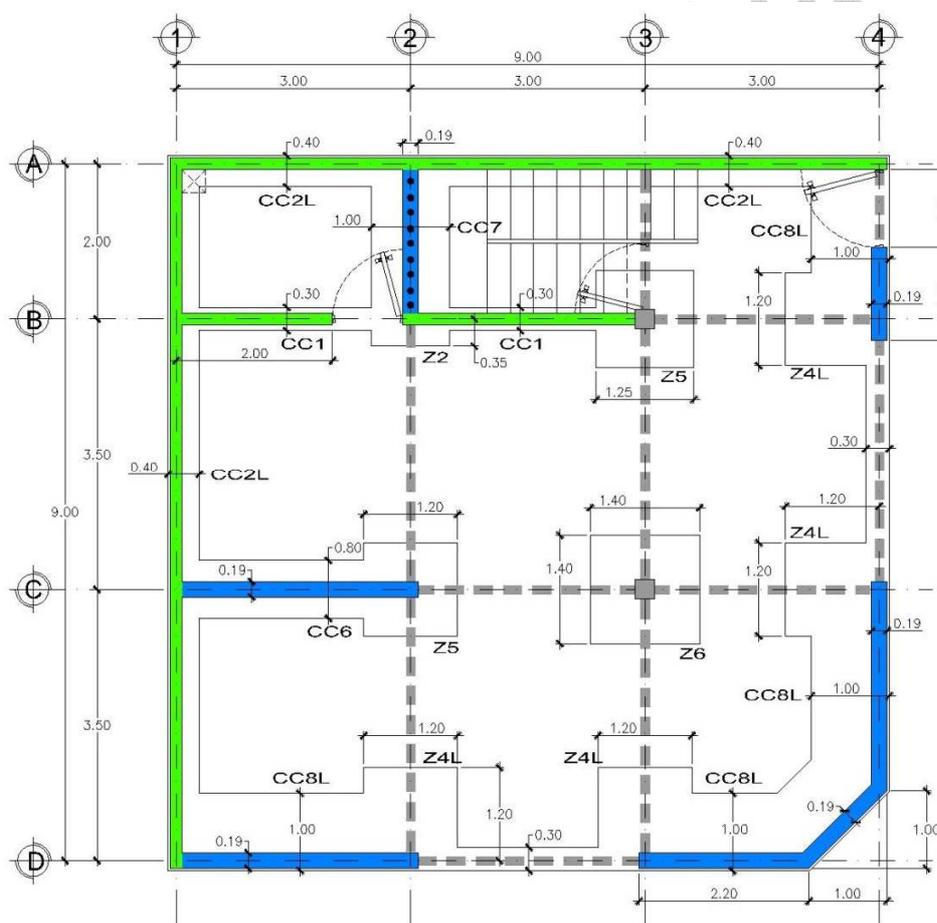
Planta de cimentación obtenida con el auxilio de los Cuadros 6-E1, 6-E2 y 6-F. No se muestran las mochetas que normalmente deberían estar representadas en esta planta -
